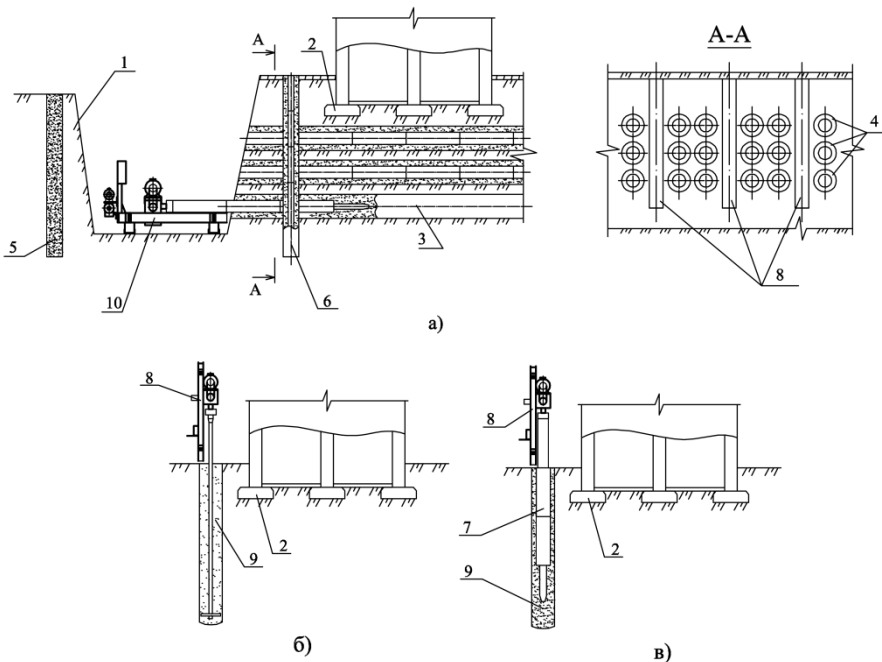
Технологічна схема підсилення основи при реконструкції та захисті будівель в стиснених умовах: а - укріплення укосів котловану та влаштування горизонтальних армоелементів; б - влаштування підпірної стінки фундаментів; в - підсилення вертикальних ґрунтоцементних елементів жорсткими конструкціями; 1 – котлован; 2 – фундамент; 3 – горизонтальні ґрунтоцементні армоелементи; 4 – горизонтальні ГЦЕ; вертикальні ГЦЕ; 5 – вертикальний ГЦЕ; 6 – вертикальний елемент підпірної стінки; 7 – бурові штанги; 8 – станок вертикального буріння; 9 - вертикальна текучопластична ґрунтоцементна суміш; 10 – станок горизонтального буріння
